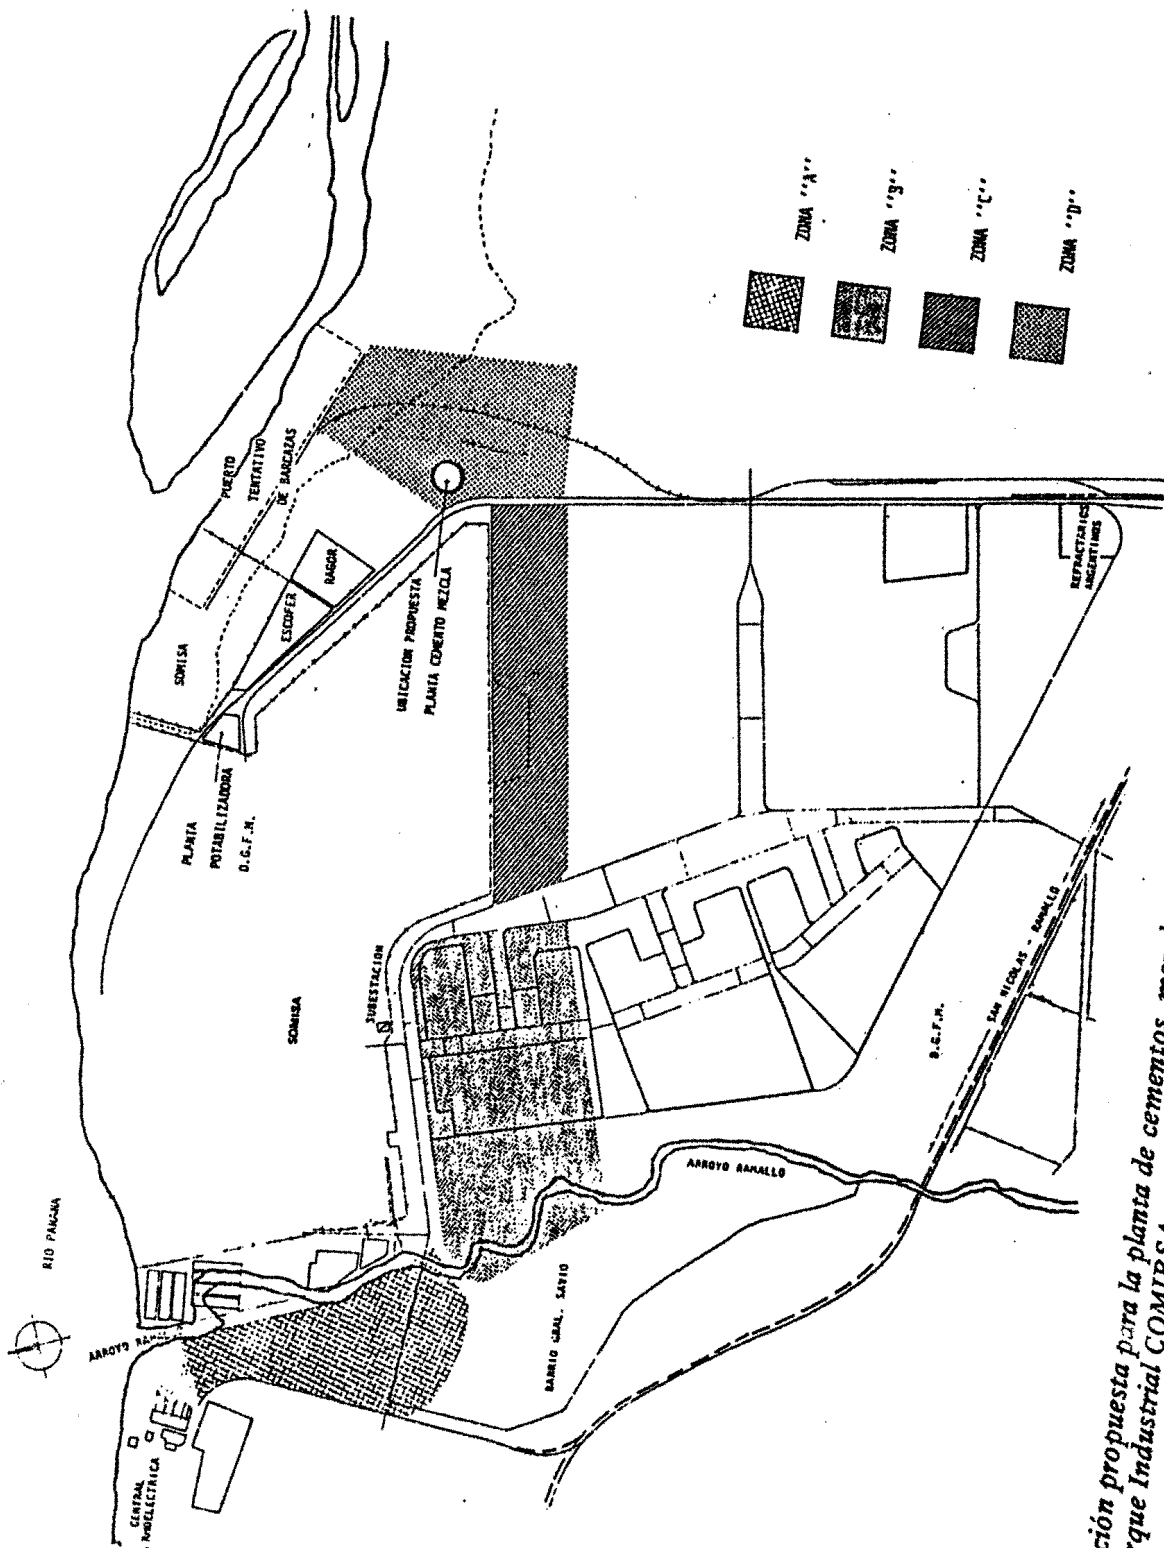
Ubicación propuesta para la planta de cementos, mezcla, dentro del Parque Industrial COMIRSA.
